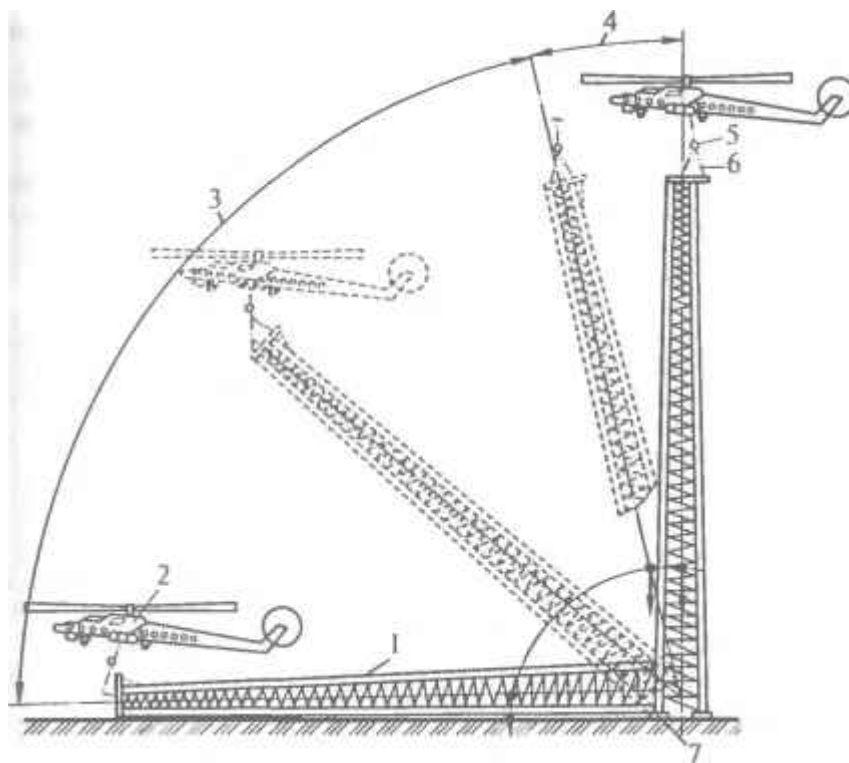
Монтаж башни поворотом вокруг шарнира:
